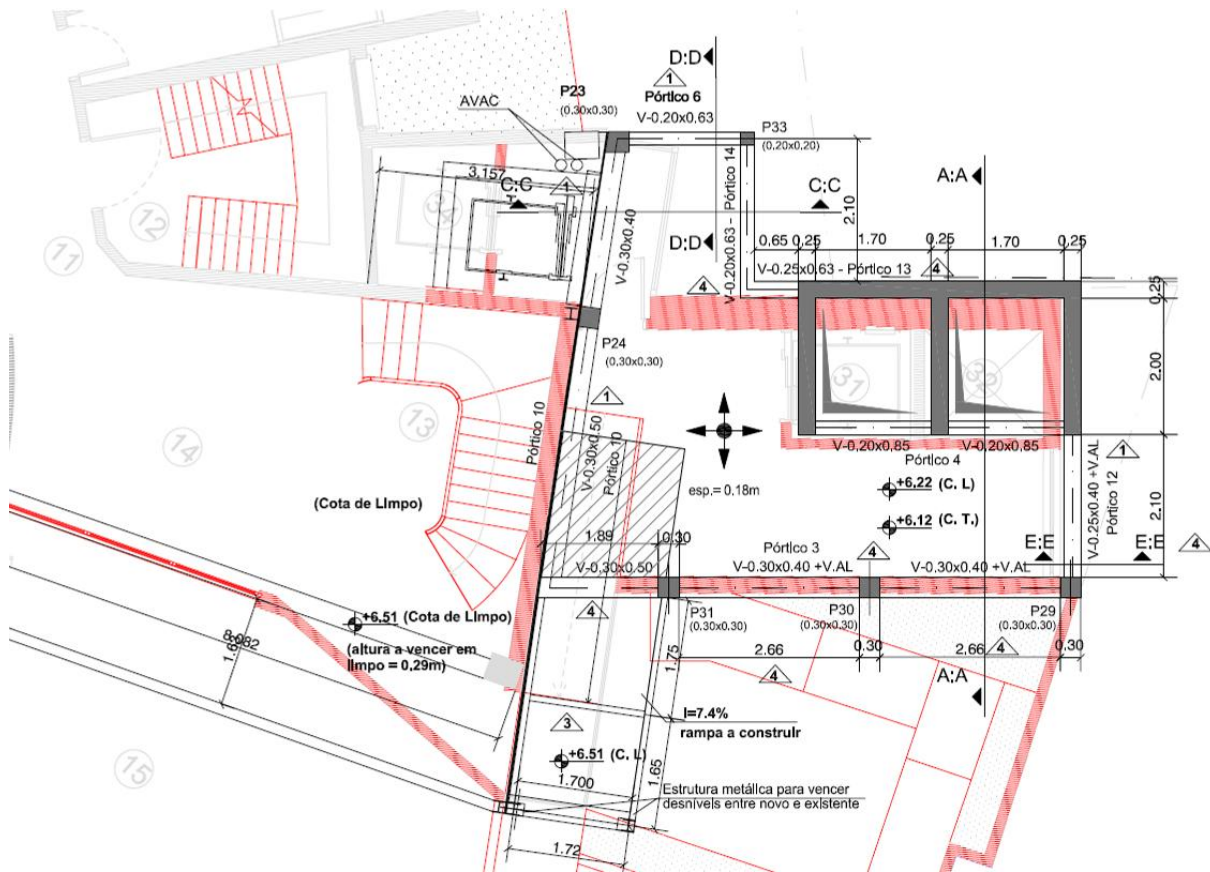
Planta do piso 2 - preparação dos trabalhos [AVicêncio A, 2017]
